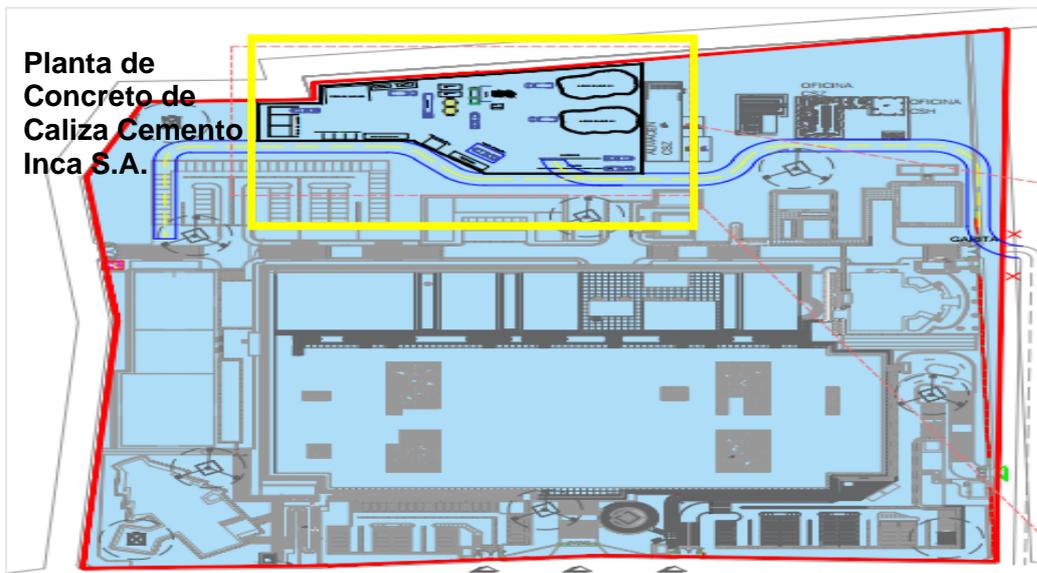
Ubicación de la planta de concreto en las instalaciones del cliente
